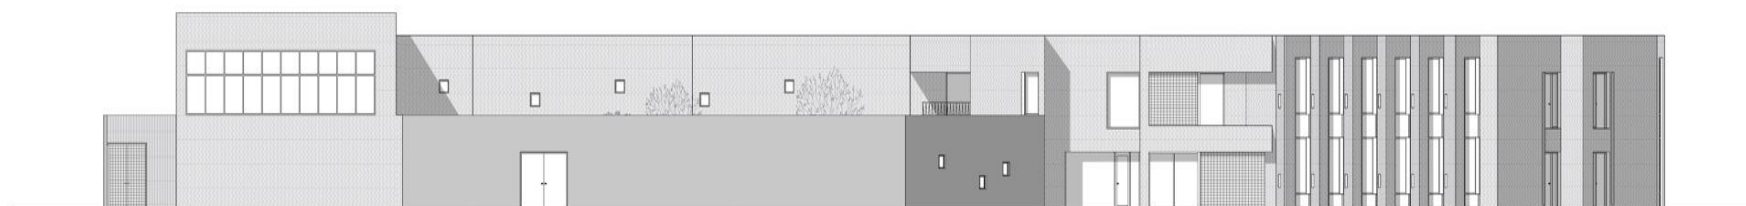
Fachada do Edifício de Celas Padrão - Fonte: MØLLER (2018).
